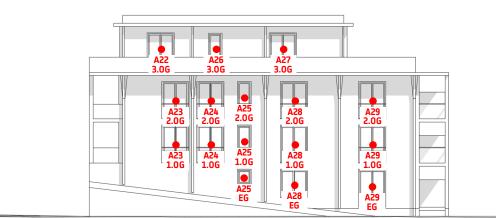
Immissionsorte Haus A, Nordwestfassade. Fassadenansicht 1:250.
